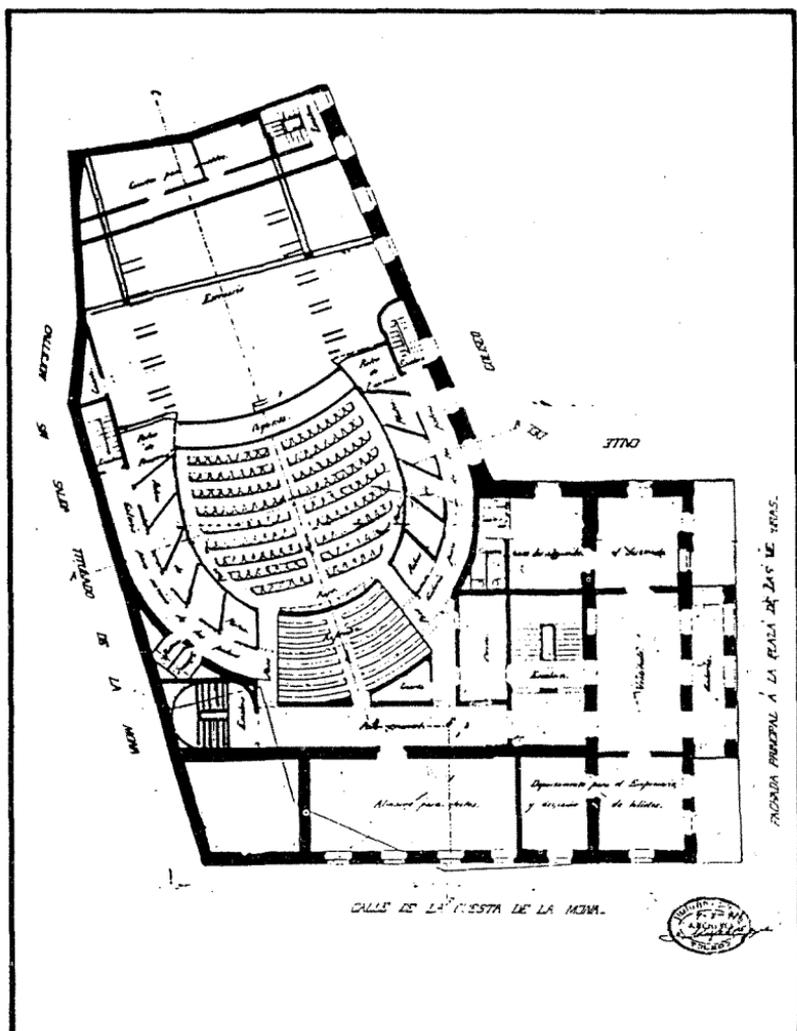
Planta del futuro teatro, según proyecto de Fenech en 1866. Niveles inferiores (A.M.T.).
